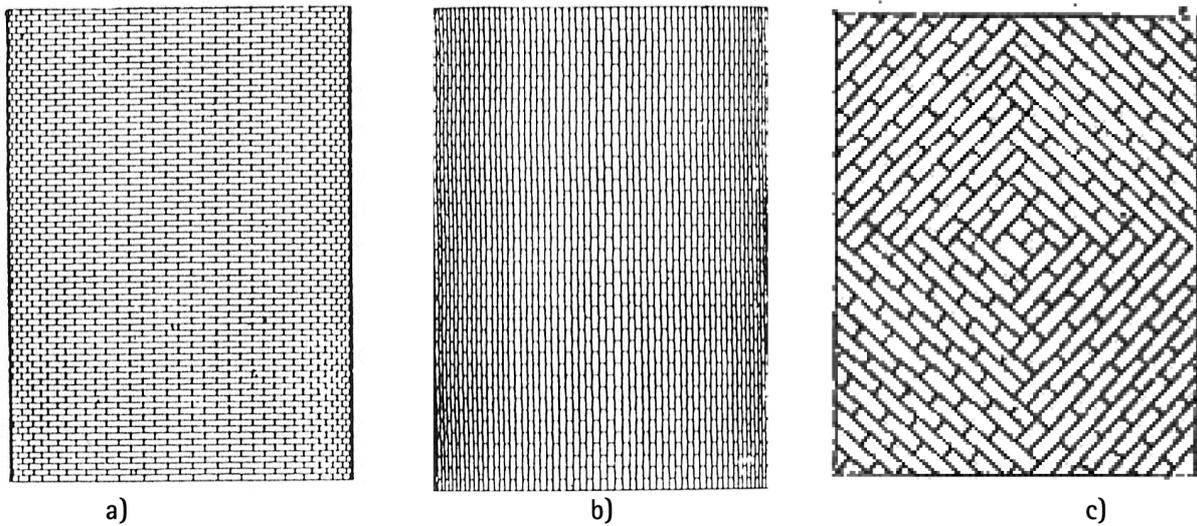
a) Apparecchio longitudinale; b) Apparecchio trasversale; c) Apparecchio a spinapesce
